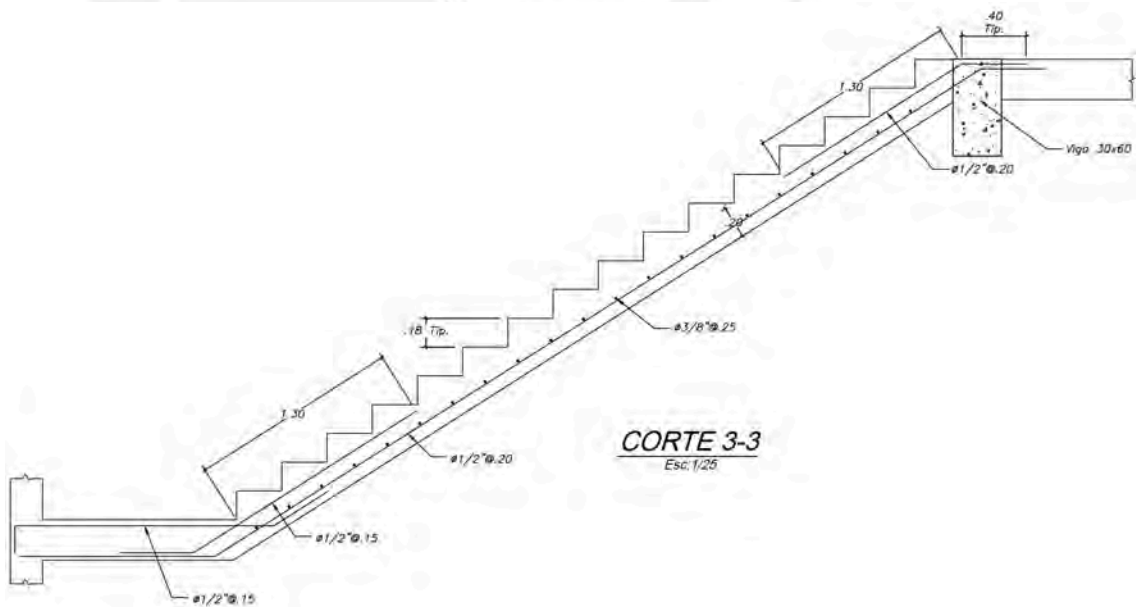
Elevación del Corte 3-3 de la Escalera
